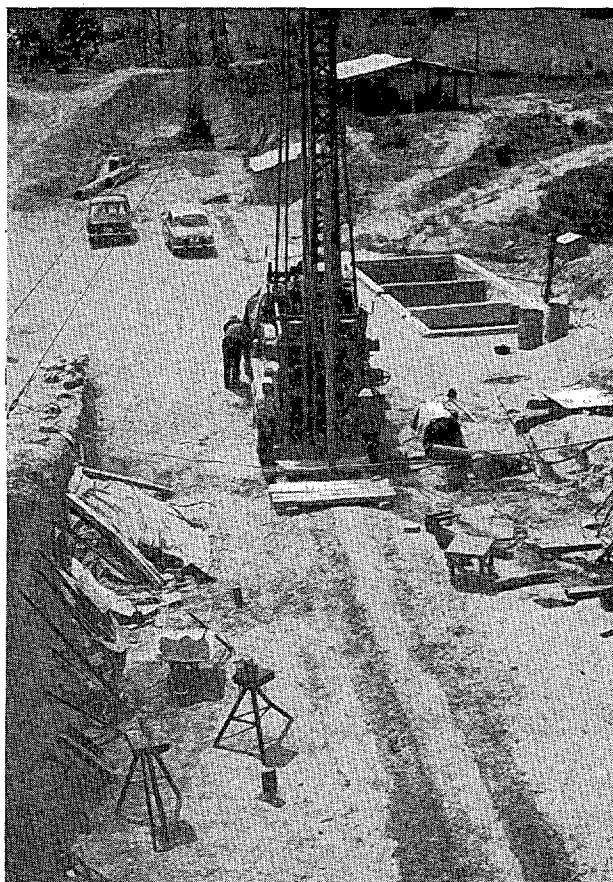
Pantalla continua de arcilla en construcción, vista de conjunto.
